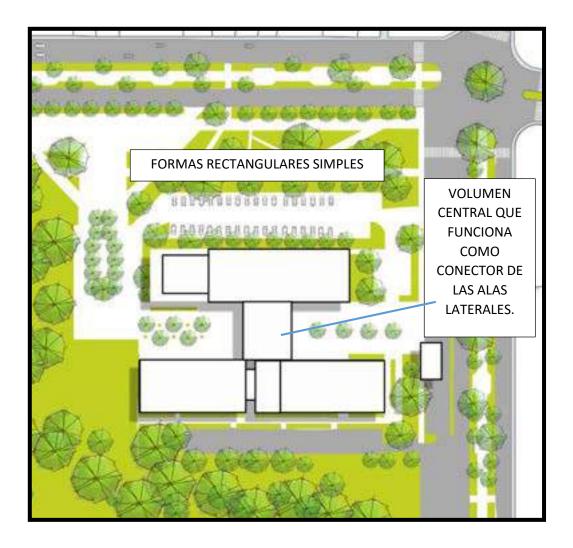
Plano indicando el sistema formal del conjunto.
